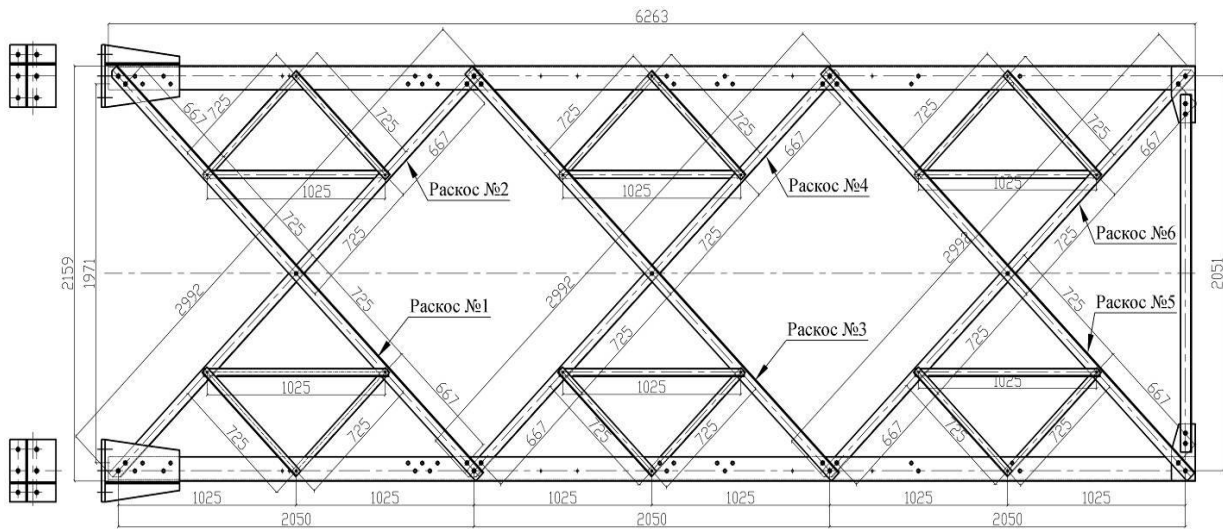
Монтажная схема испытуемой плоской фермы (раскосы из уголков L63x5)
